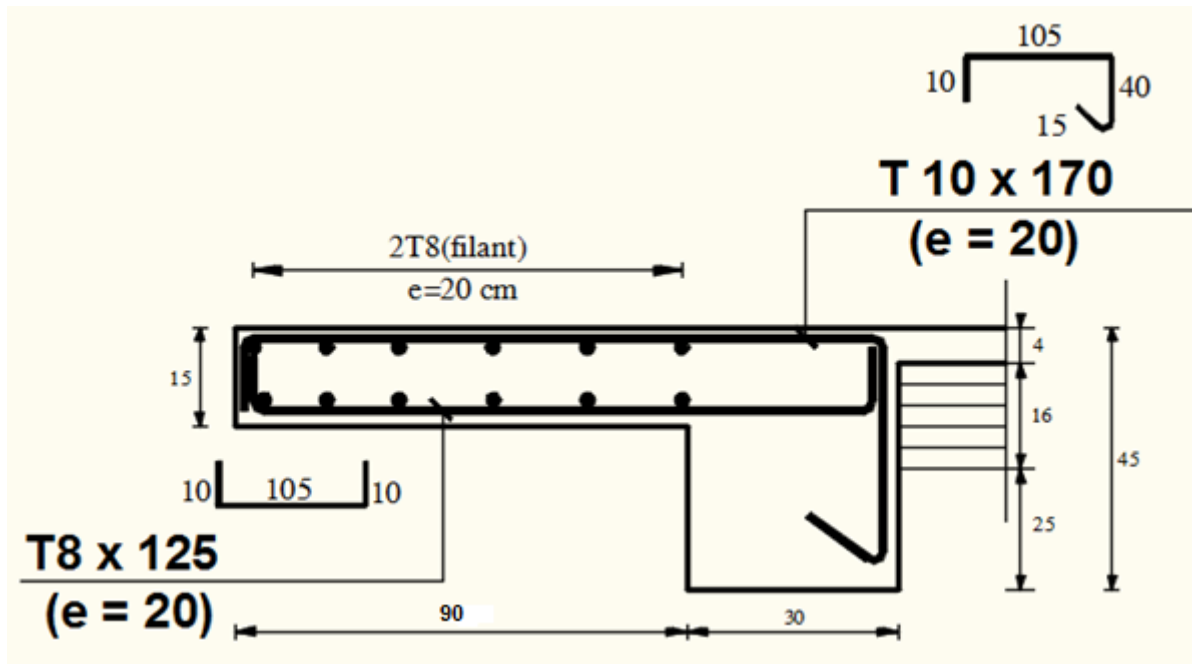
Schéma de ferrailage balcon type 2.
